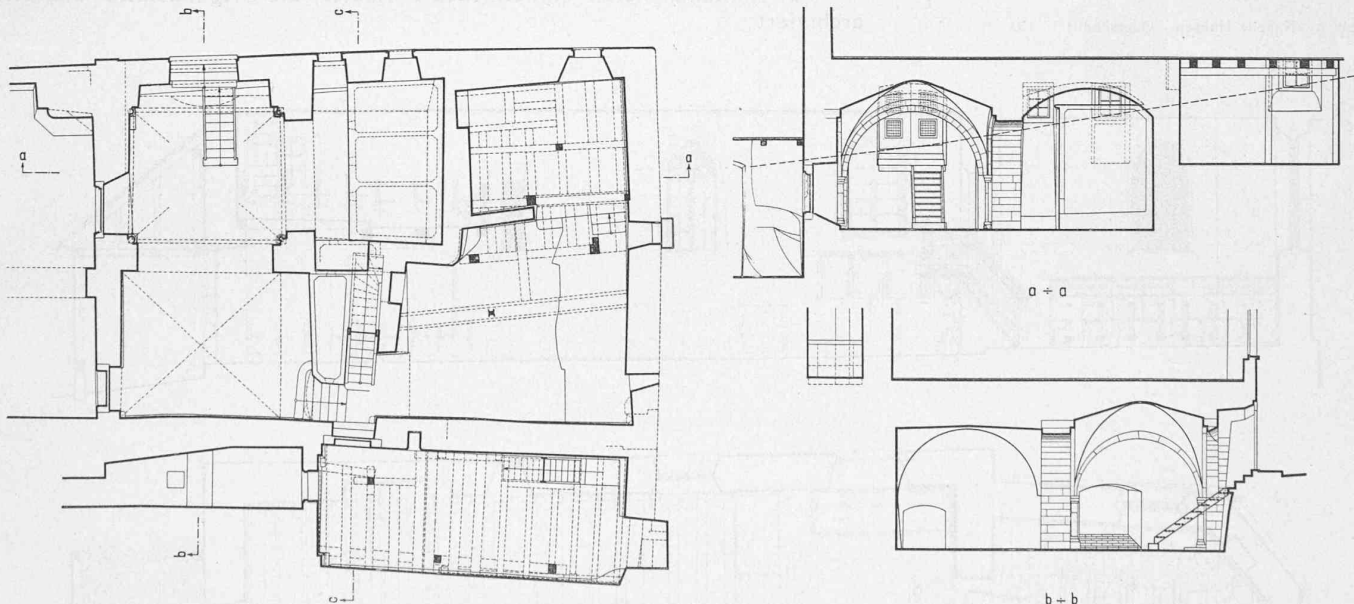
bis 3. Grundriss und Schnitte eines Keller-Gewölbes im Eckhaus Schoffelgasse-Münstergasse Nr. 15 in Zürich. — Masstab 1 : 200.
